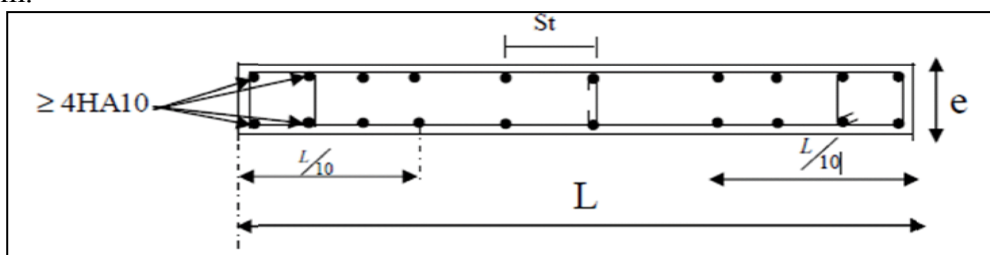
Disposition des armatures verticales dans les voiles
